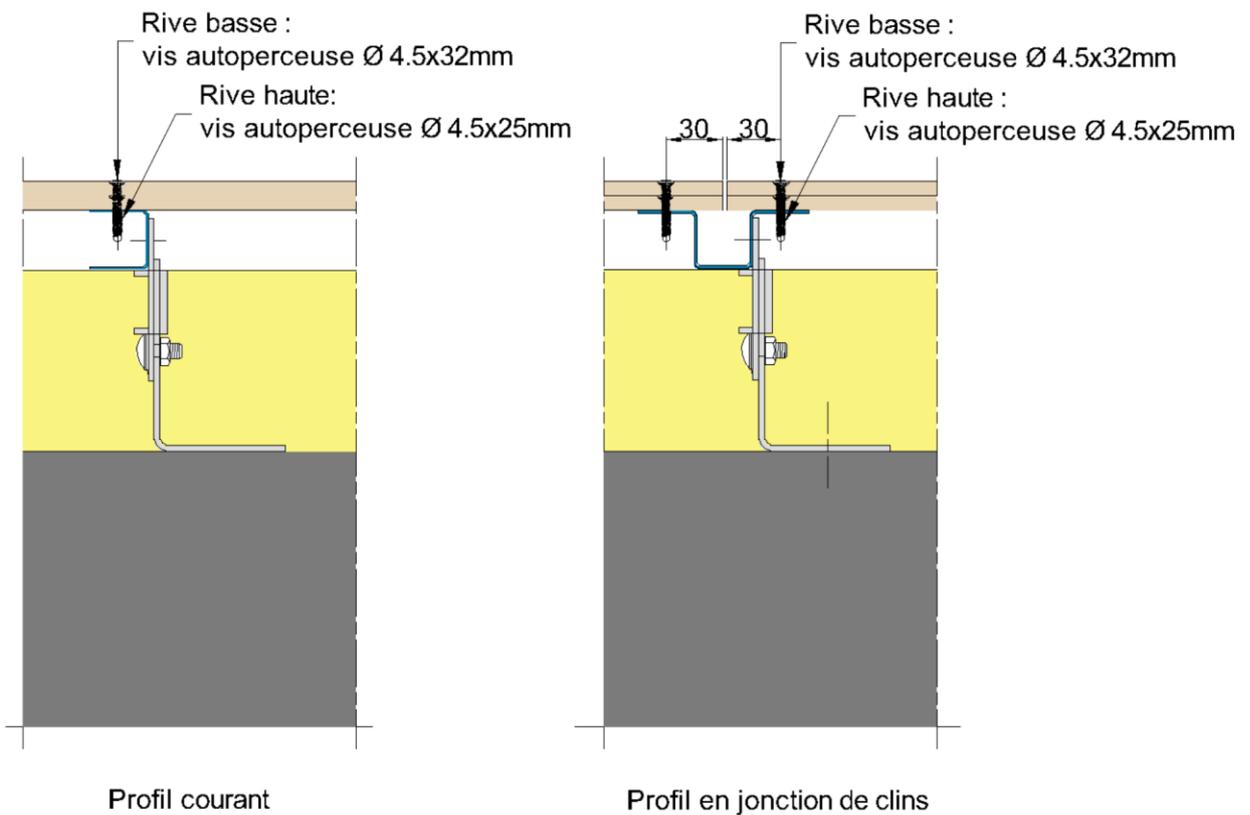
Pose sur ossature métallique – Fixation rive haute et basse de la lame CEDRAL LAP pose horizontale
